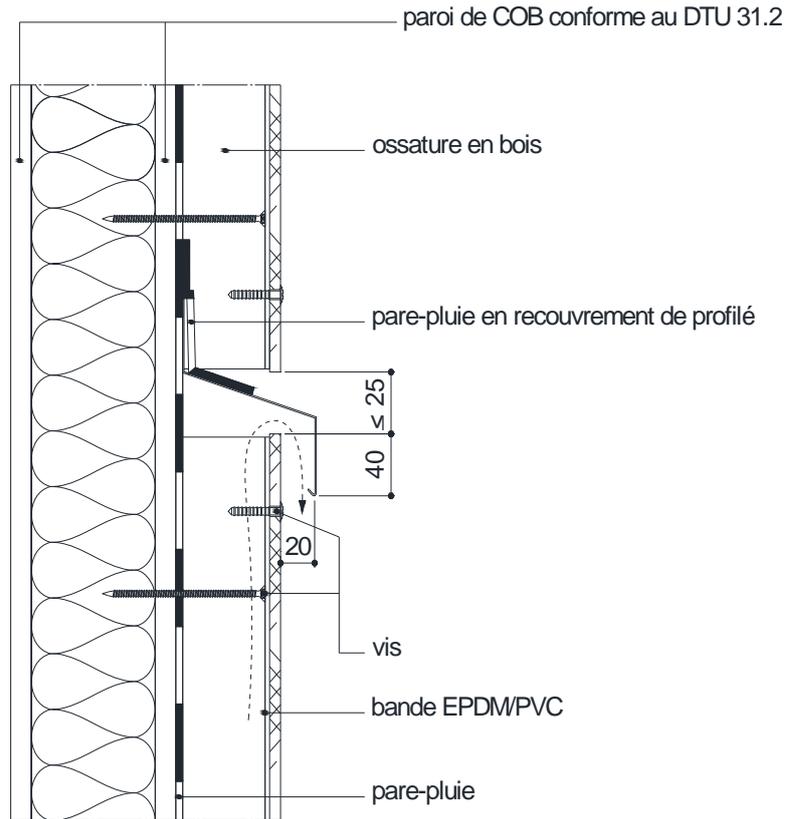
Recouvrement de pare-pluie tous les 6 m sur COB (cote en mm)
